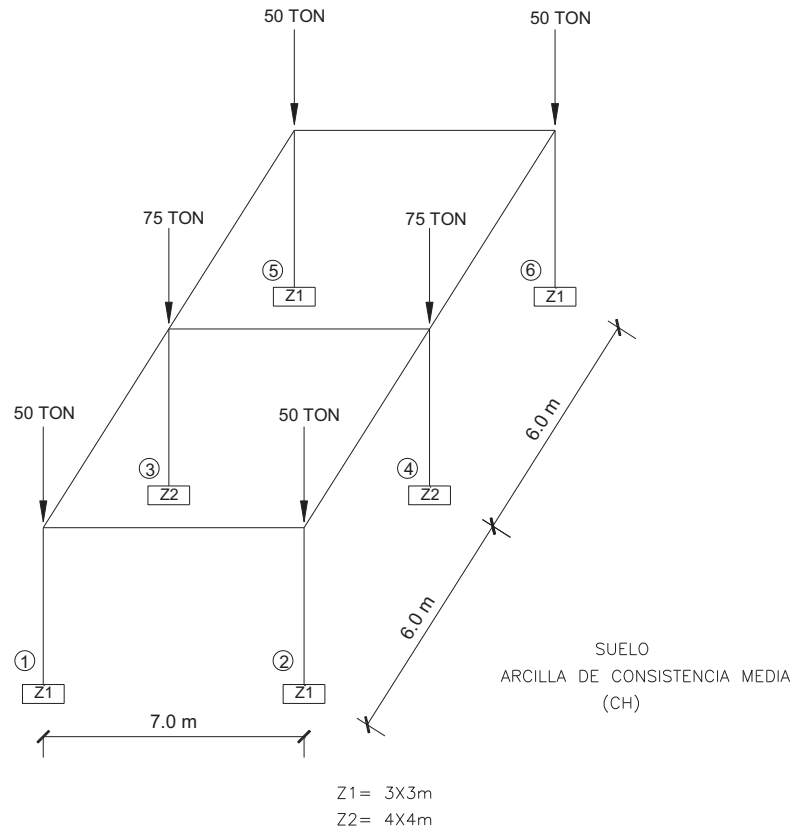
Representación de una Estructura Cimentada con Zapatas Asiladas
